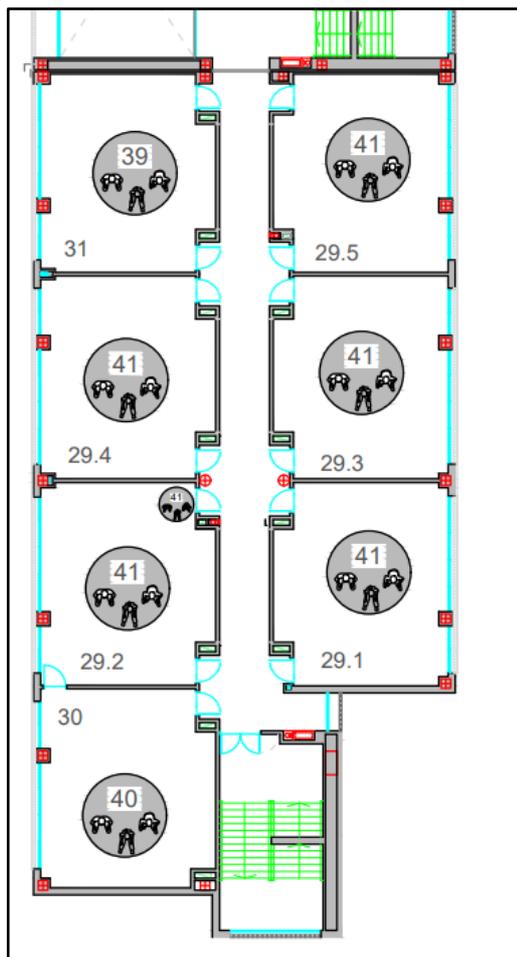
Plano con ocupación por aula de la planta uno – mitad inferior
